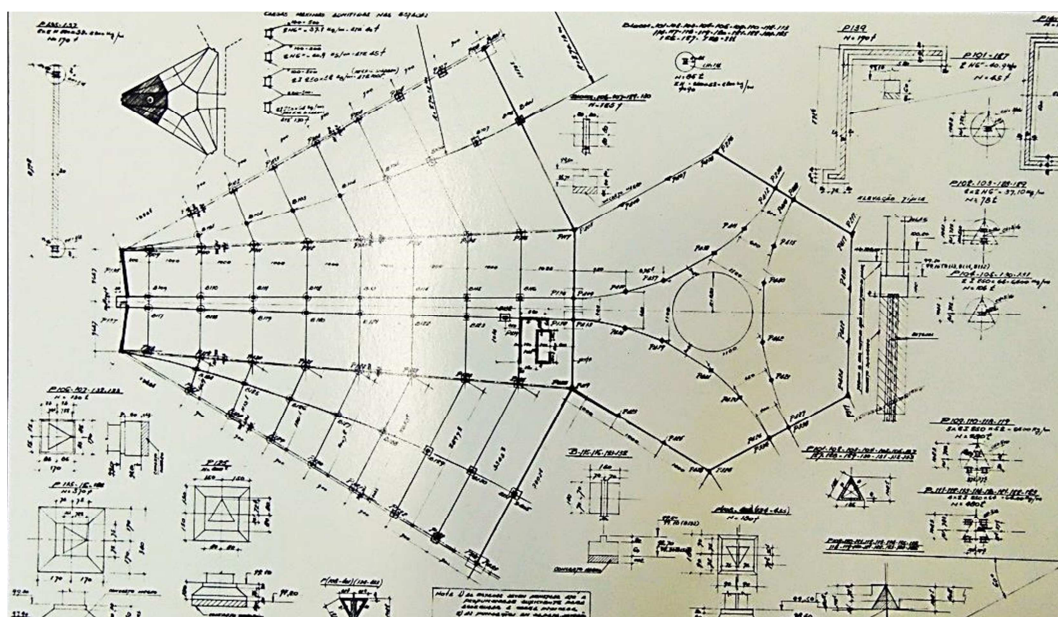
Sergio Bernardes, ESG, DF, 1970/74. Planta estrutural – fundações/ localização/ fôrmas setor 1 subsolo. Fonte: Acervo Sergio Bernardes - NPD/UFRJ.
